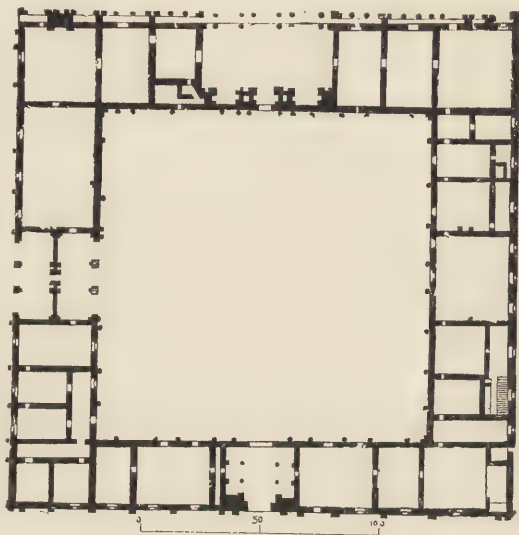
Palazzo del Te zu Mantua. Grundriss.
